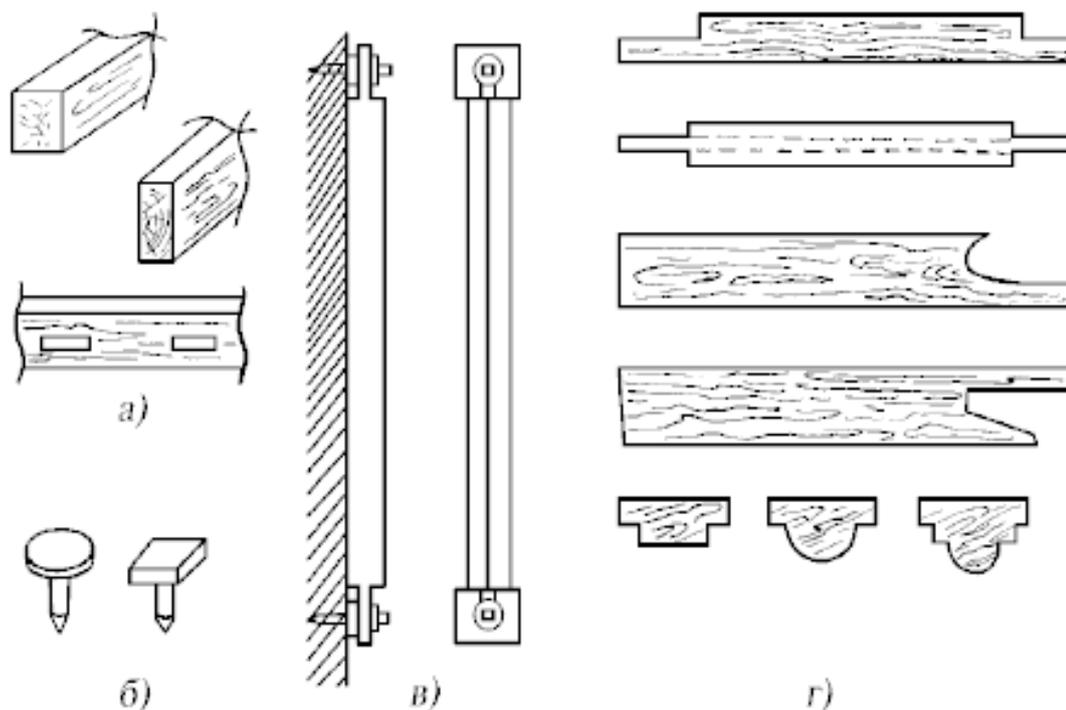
Приспособления для штукатурных работ: а) правила; б) стальные малки; в) инвентарные металлические маяки; г) малки
